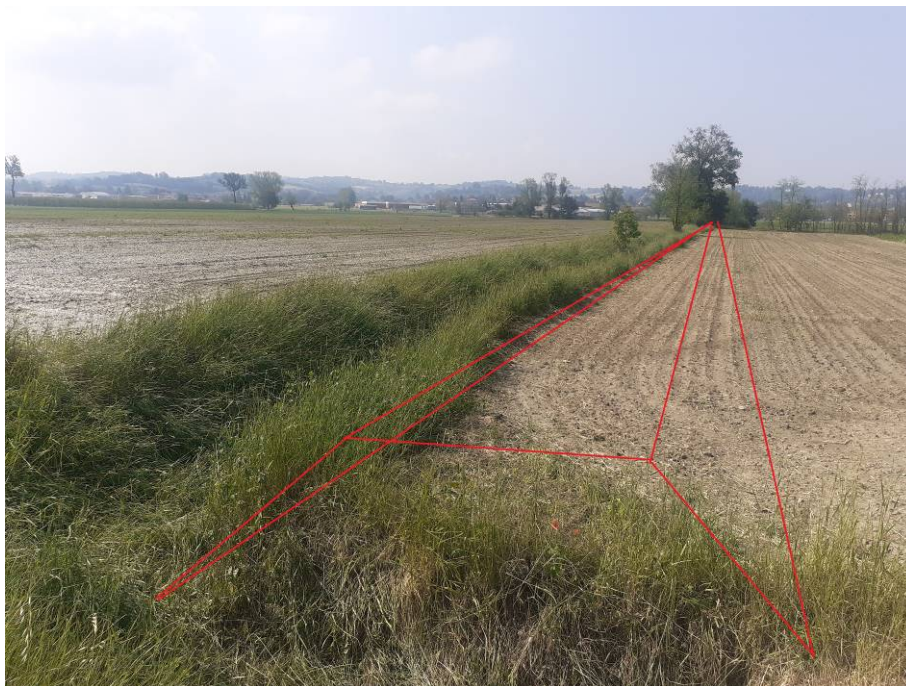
Strada Montemerla, zona di attacco del manufatto in progetto. Le linee rosse materializzano il rilevato del manufatto di protezione in progetto
